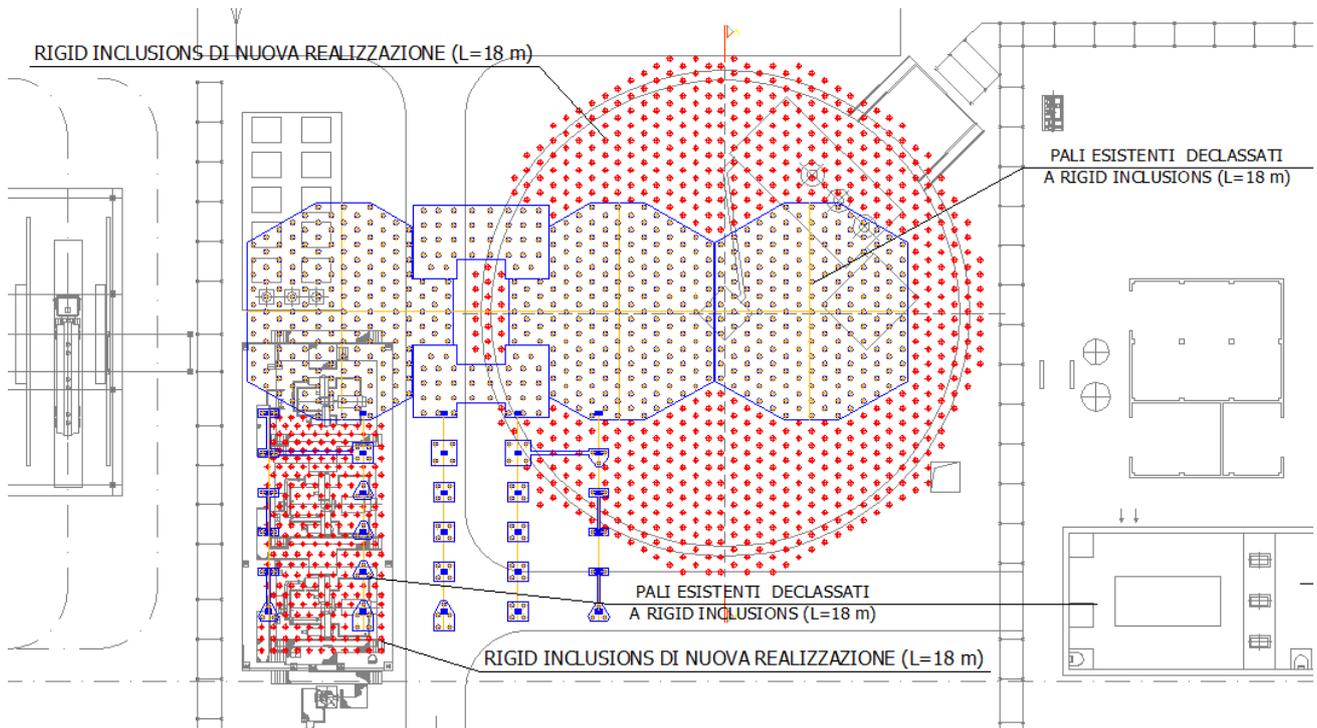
o: Pianta Fondazioni Serbatoio e Compressori
